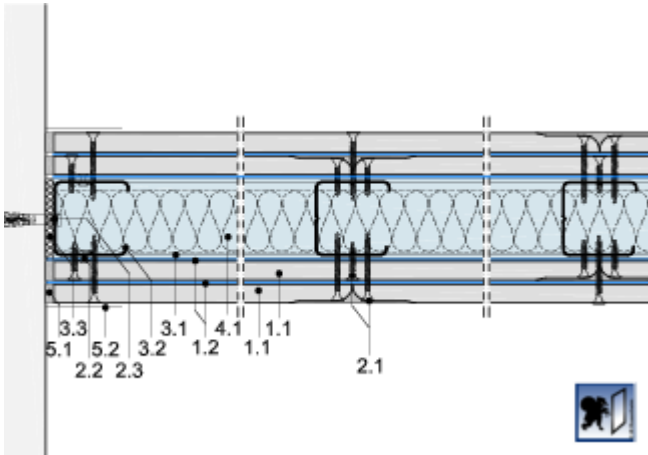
Gleitender Deckenanschluss Doppelständerwand RC 3 mit erhöhtem Schallschutz
